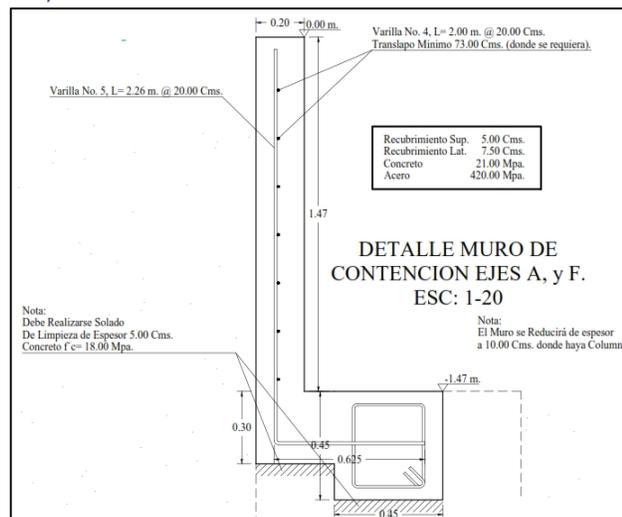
, Detalle de muro de contención eje A, y F, Fuente: Constructora Open House.
